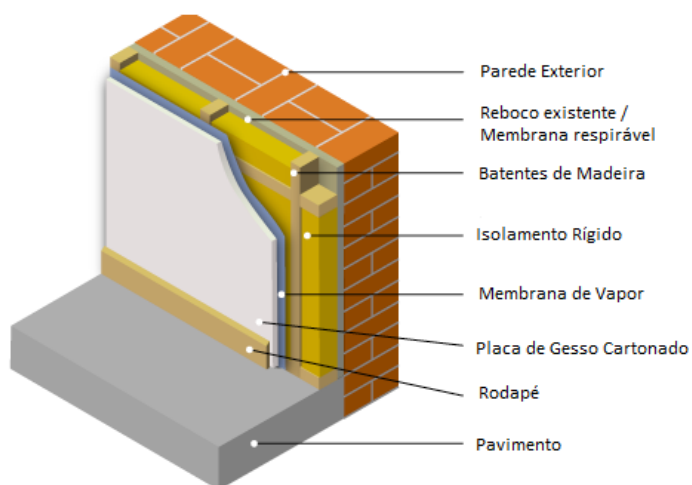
Exemplo de parede com isolamento pelo interior. [52]
